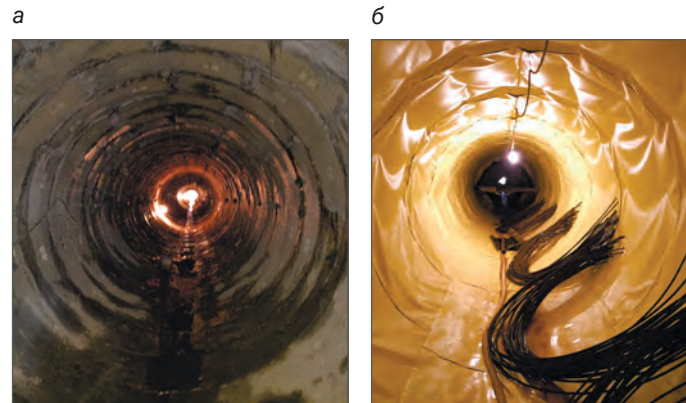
Пример установки полимерной рулонной гидроизоляции при отрицательном давлении воды: а — первичная сборная железобетонная обделка тоннеля с многочисленными водопотоками в швах бетонных блоков; б — смонтированная полимерная рулонная гидроизоляция
